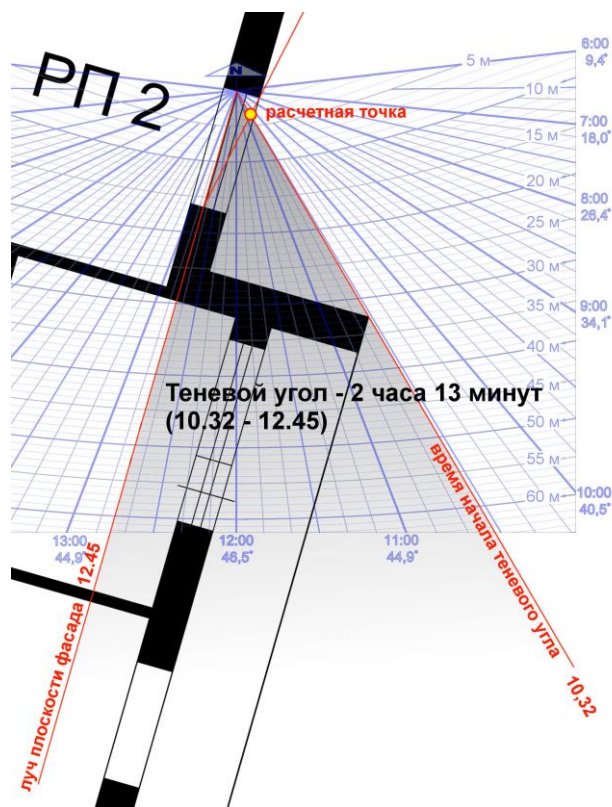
Схема совмещения ИЛ и плана квартиры для определения периода времени начала теневого угла (схема плана)
